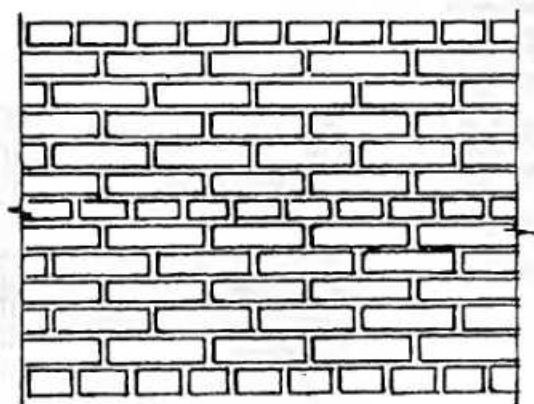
П'ятирядна кладка стіни в дві цегли (вигляд з фасаду)
